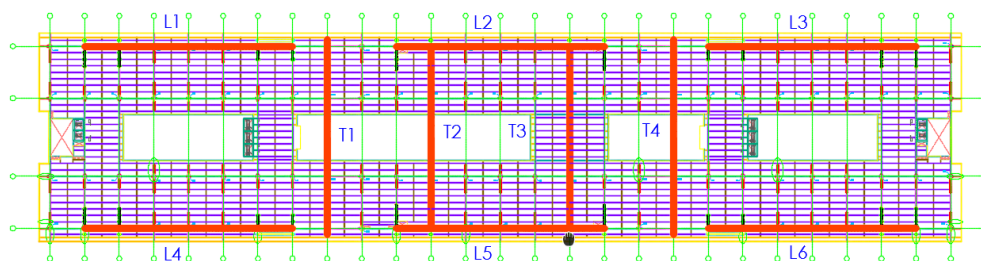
Vigas-puente transversales en último piso de Plataforma Social.
